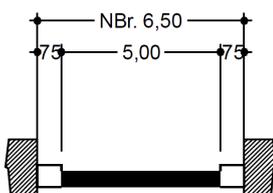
BW 64-b, geplanter Brückenquerschnitt mit oben liegendem Tragwerk
